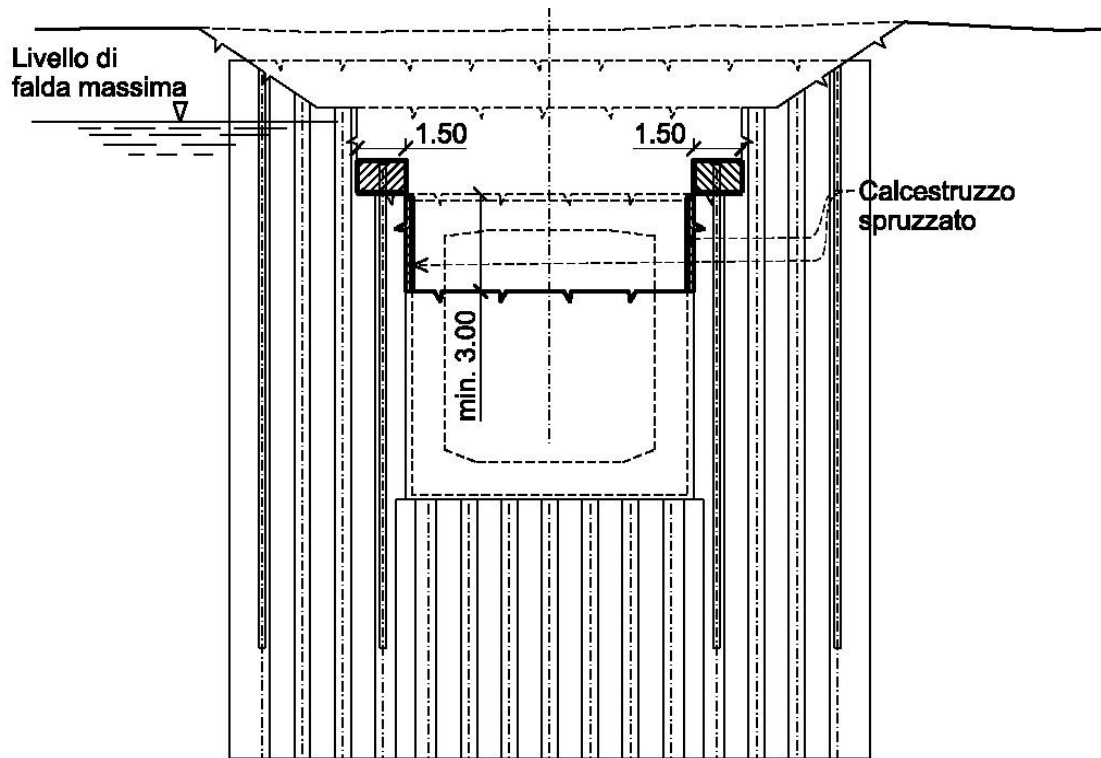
Aushubvertiefung zum Bau der provisorischen Streben und Behandlung der Baugrubenwände mit Spritzbeton
